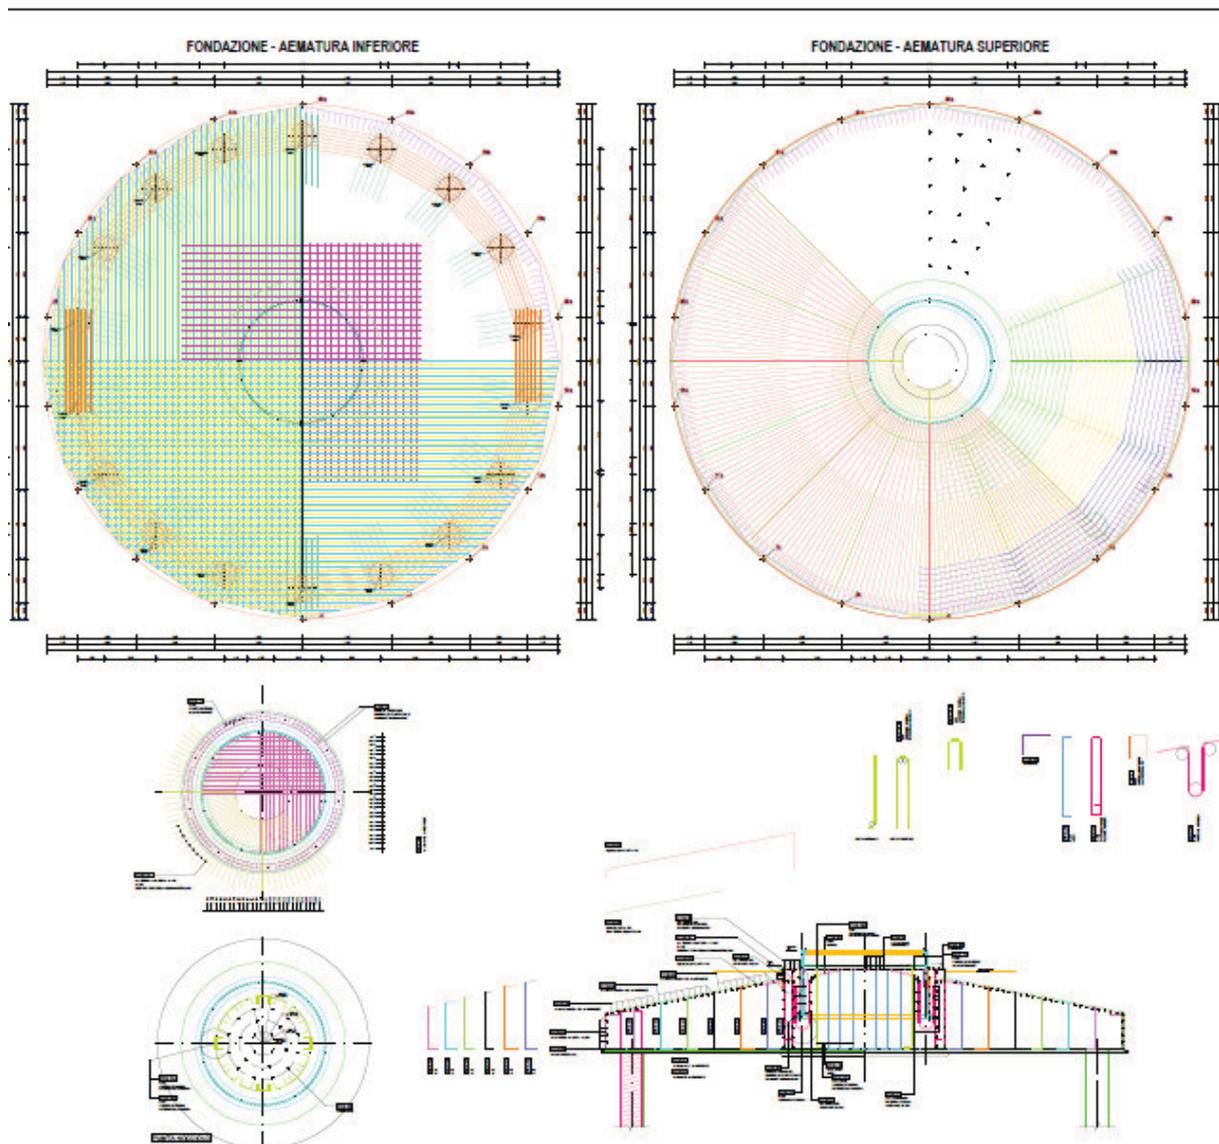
Pianta-sezioni e armature del plinto di fondazione
